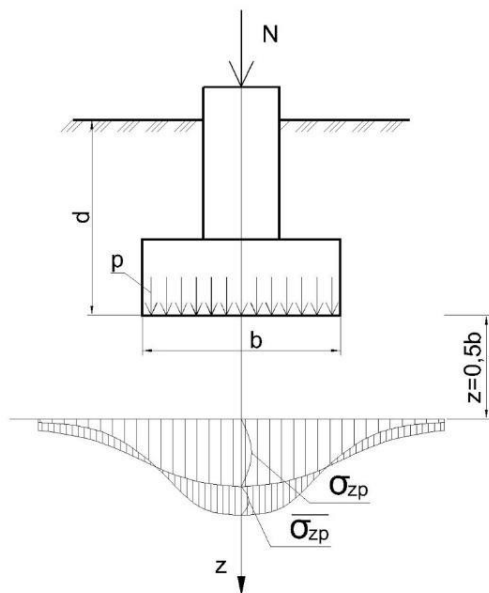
Схемы к расчету усиления подошвы фундамента
